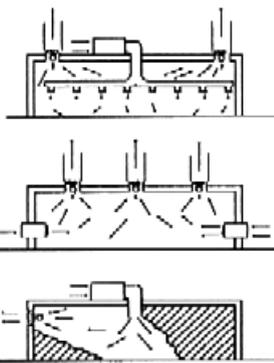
Sistema meccanico di ventilazione generale. In basso la disposizione delle bocche di immissione ed estrazione non ricambia l'aria nelle zone tratteggiate. Al centro una disposizione accettabile che tuttavia favorisce il ricambio alle testate del locale. In alto il sistema più efficiente.
